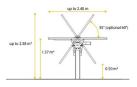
Sezione tipo del progetto agrivoltaico con alternanza pannelli fotovoltaici/coltivazione e particolare modulo
